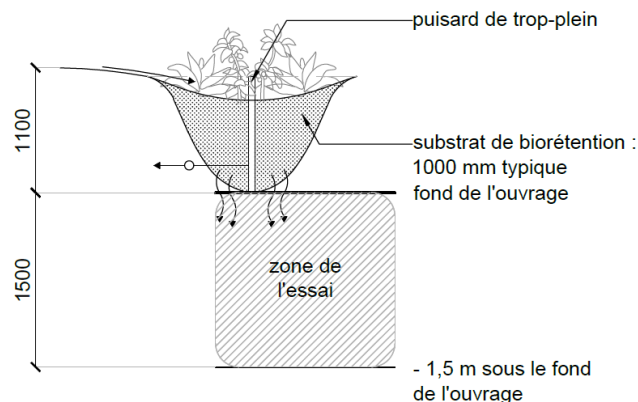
Zone typique de l'essai pour l'évaluation de la conductivité hydraulique
